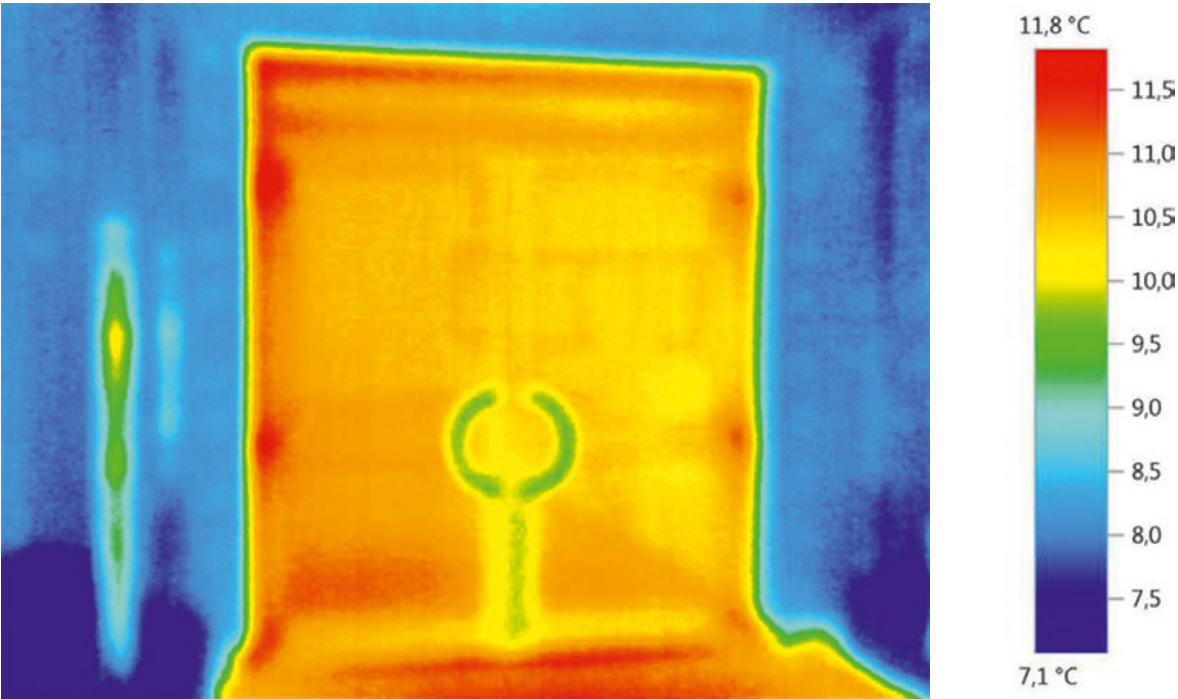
Aufnahme einer Haustür mit Wärmebildkamera [Quelle: PfB – Außentür Halle 2002]
